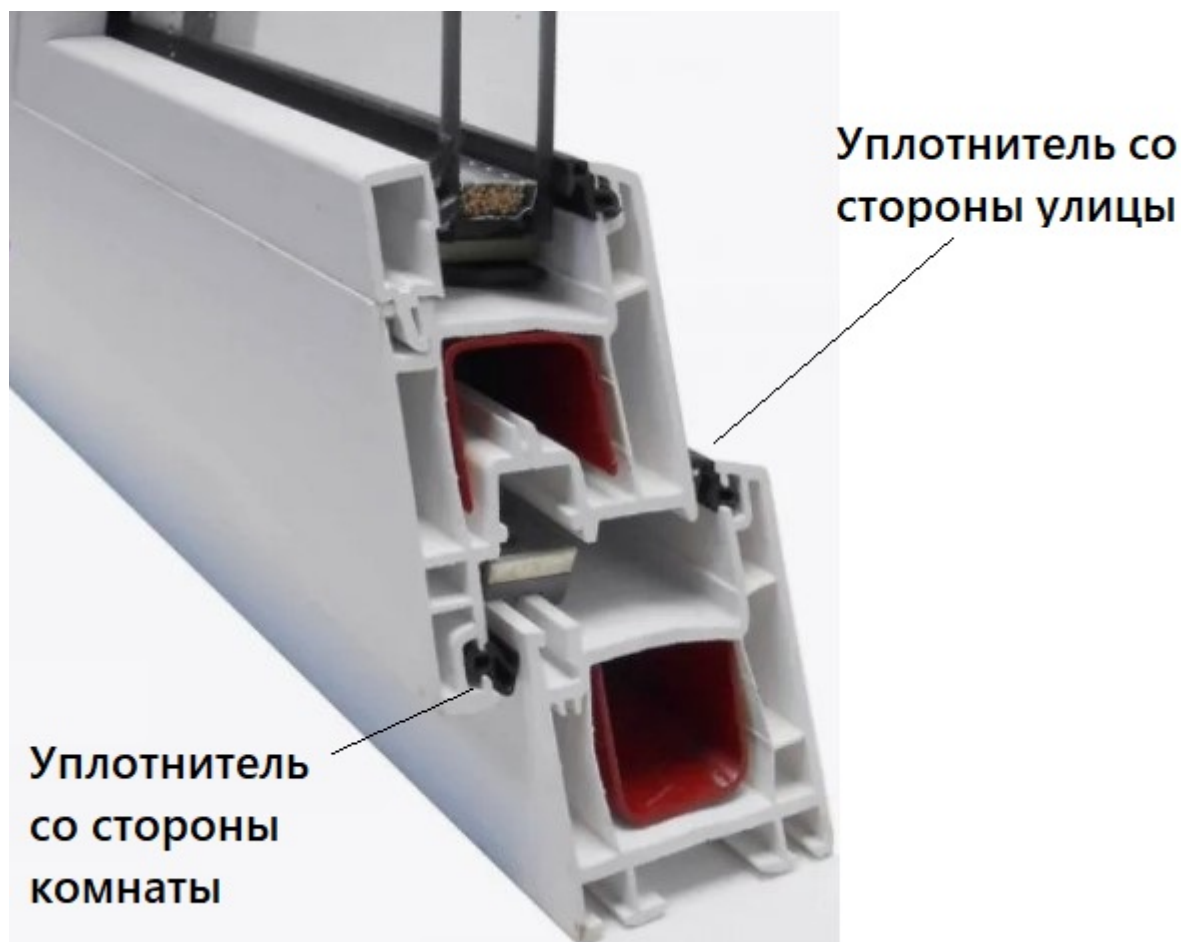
Оконный уплотнитель, расположенный на прижипе створки к коробке
